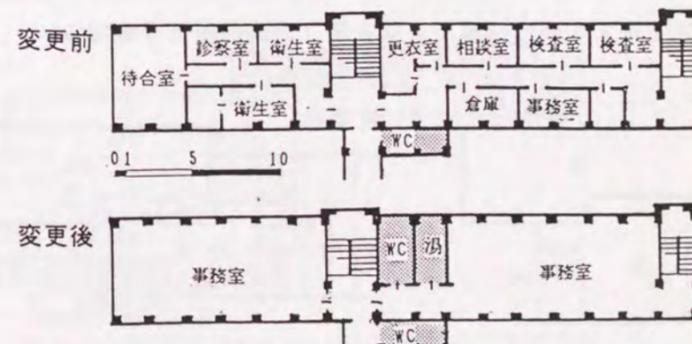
<90>京都市西庁舎(旧保健所)一般階平面図
